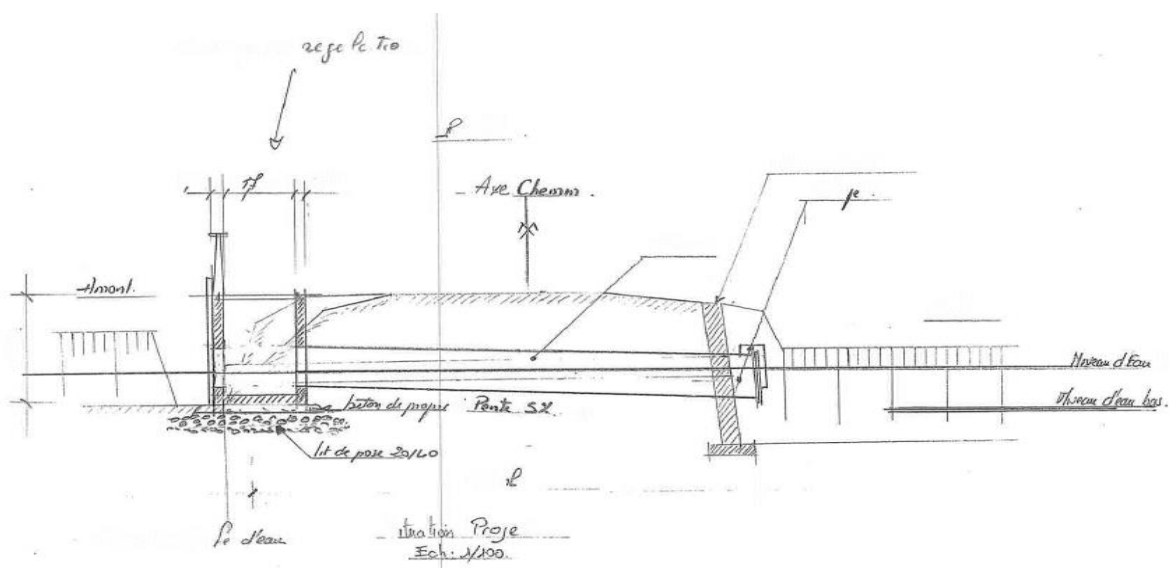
Coupe de principe de l'ouvrage hydraulique des Sartières [R2]
